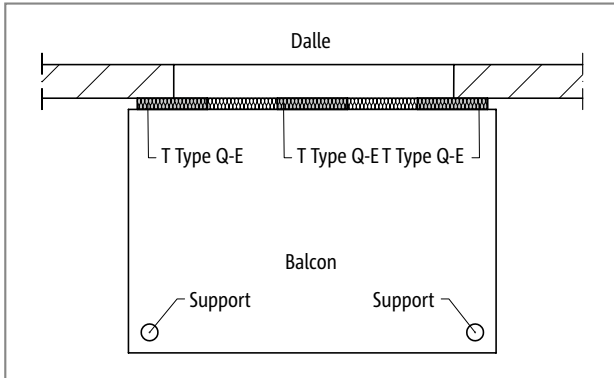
Schöck Isokorb® T Type Q-E : Balcon soutenu
